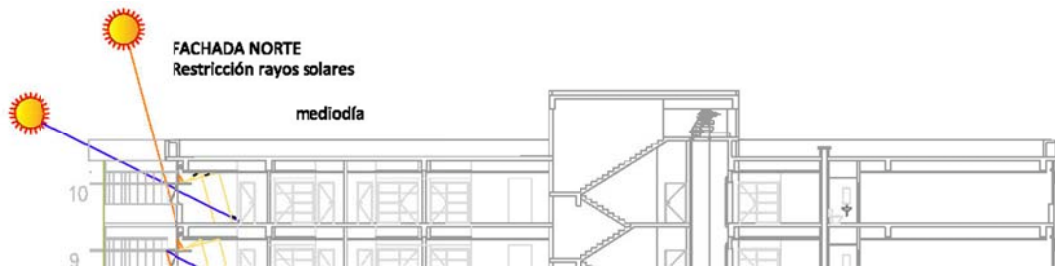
Radiación en fachada norte. Sector del corte A-A.
